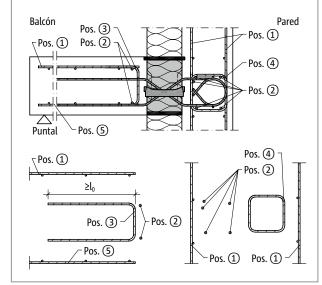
Schöck Isokorb $^{\circ}$ XT tipo Q-VV1 hasta VV4: Armadura in situ en el muro
